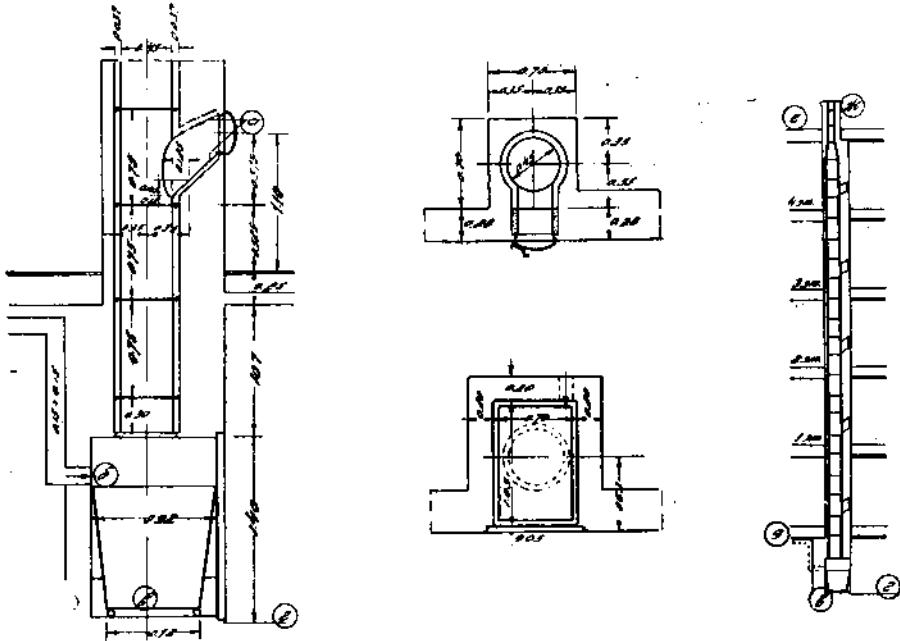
Разрез шахты мусоропровода: а) загрузочная камера зажелезнена и гладко ошлифована цементным раствором, б) вентиляционный канал из камеры хранения мусора, в) сборник мусора, г) подвал, д) первый этаж, е) кровля, ж) диаметр трубы 270 мм
